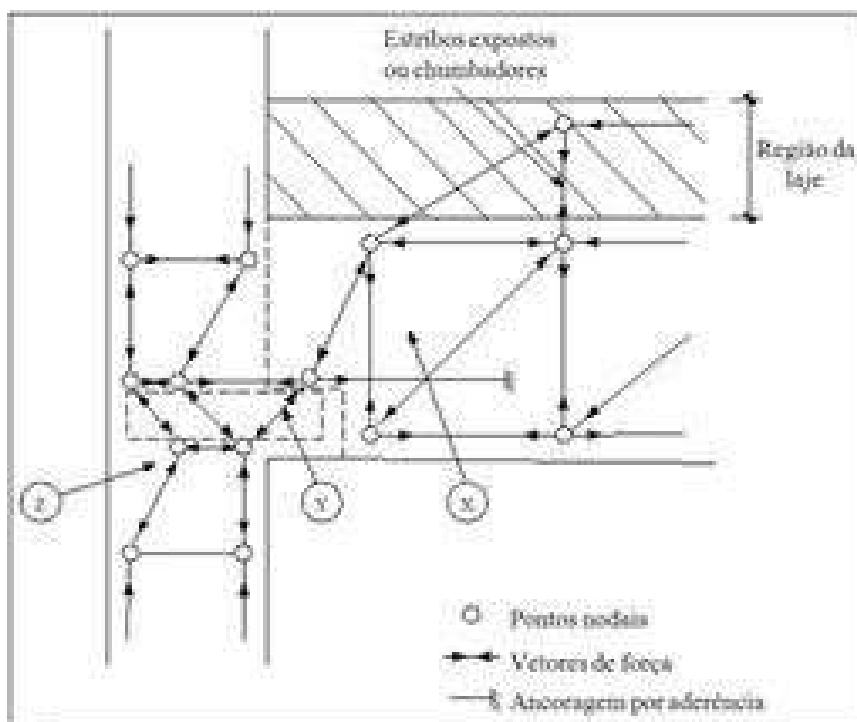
Separação das trajetórias de forças na ligação viga-pilar com consolo Metálico
